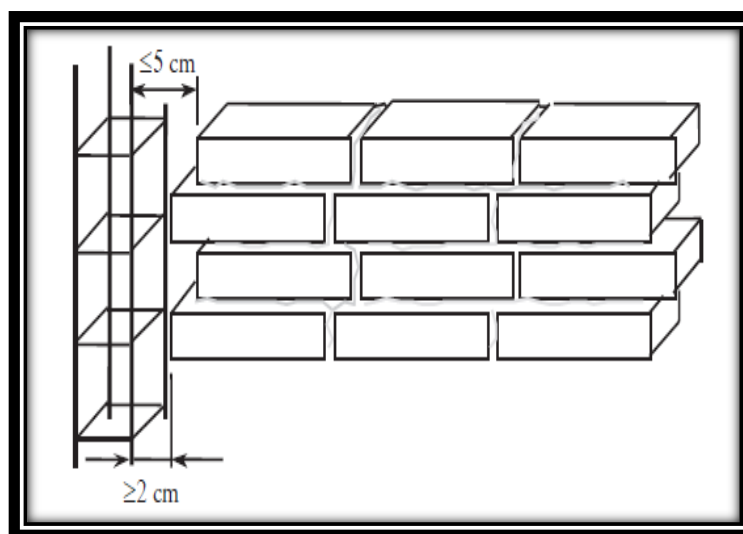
Distancias mínimas al pilar en albañilería reforzada
